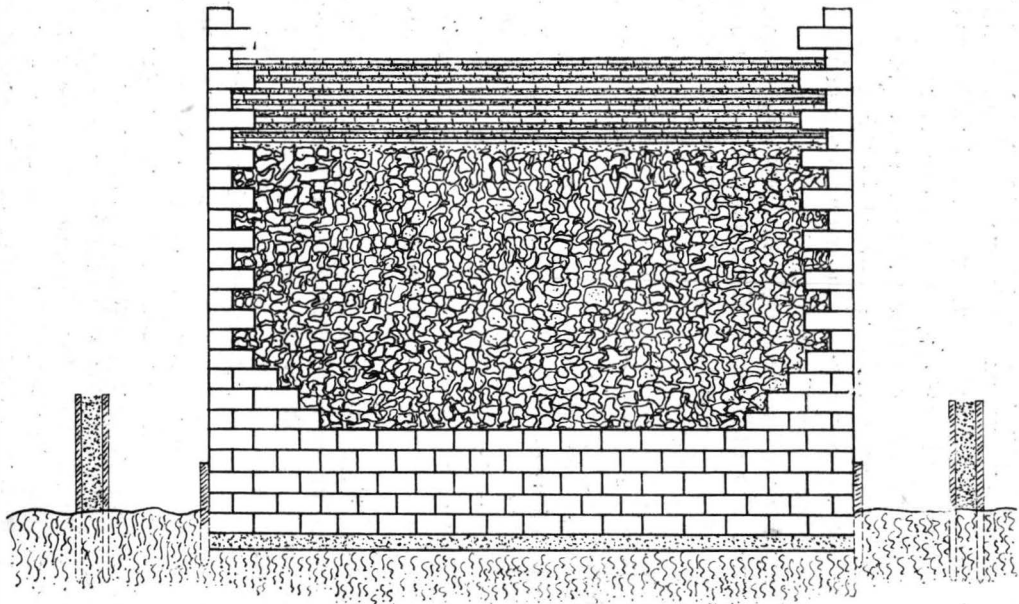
Secțiune pe lățimea unei pile (reconstituire)
